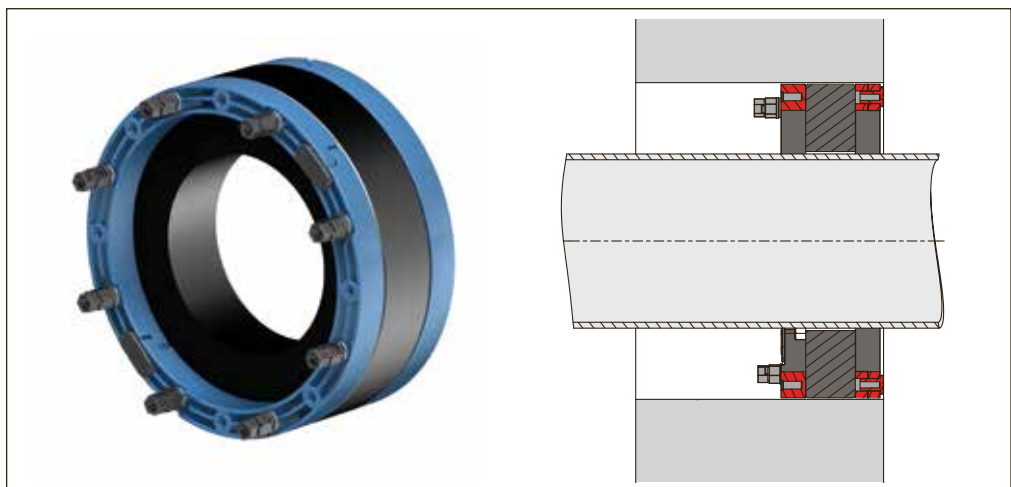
Manchette étanche au radon pour un passage mural pour tuyau (source: Rematec AG).
